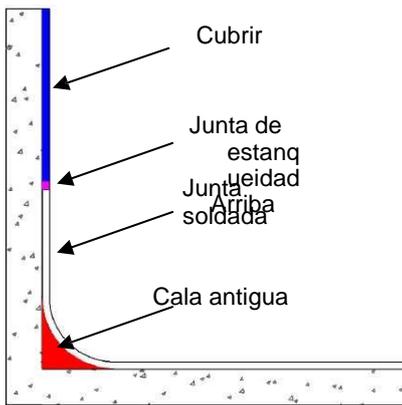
Montante de suelo de PVC: soldadura/unión directa
